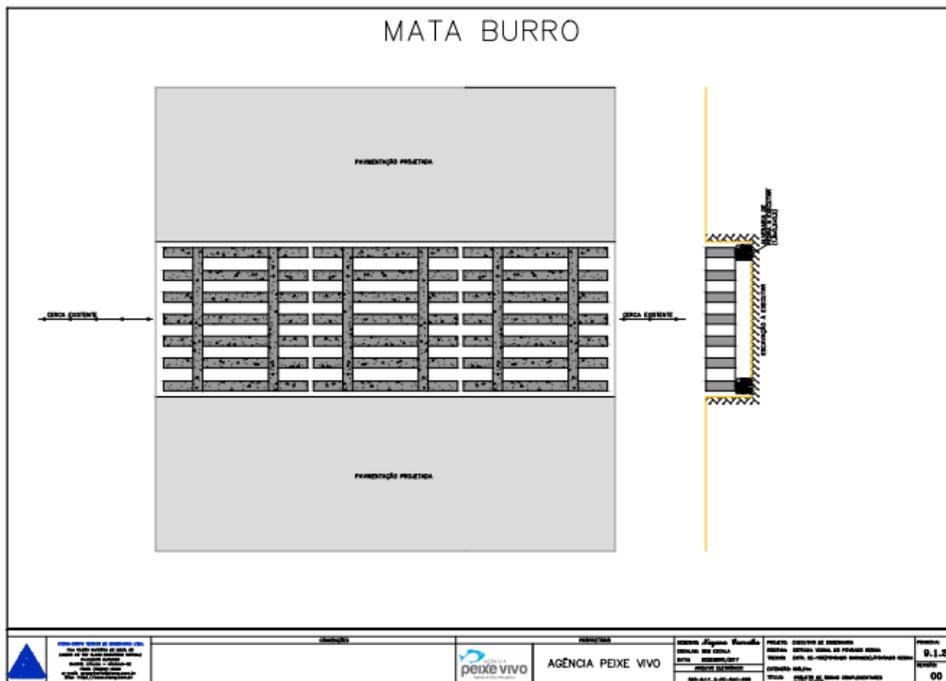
b - Vista superior com detalhe de mata-burro a ser implantado na estrada do Povoado Resina.
